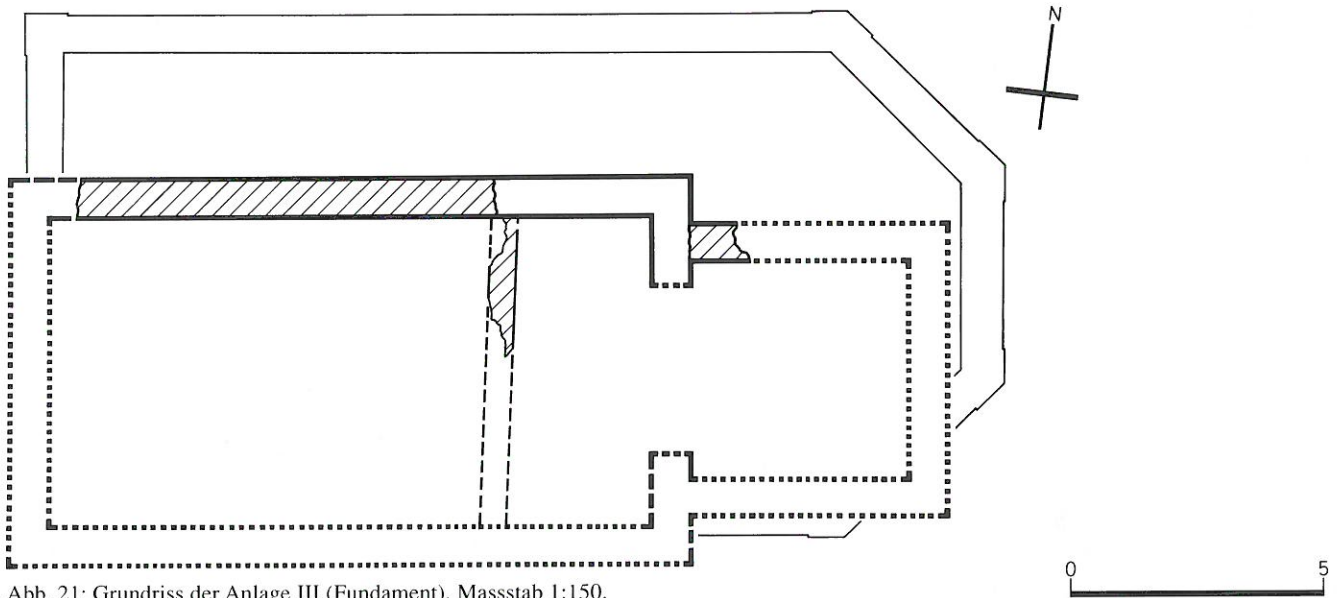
Grundriss der Anlage III (Fundament). Massstab 1:150.
